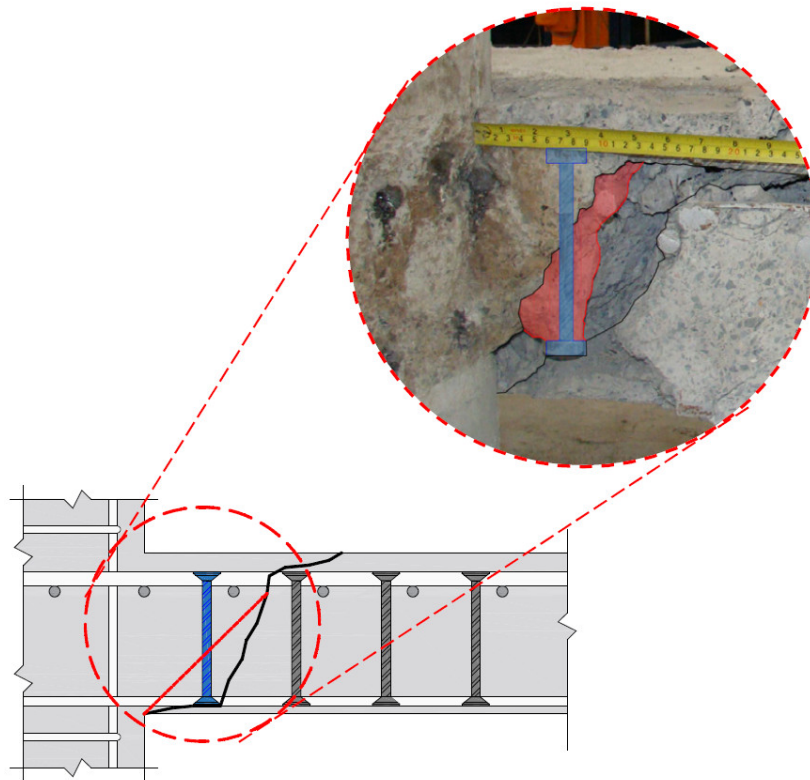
Possível evidência de armadura de cisalhamento falhando pelo arrancamento do cone de concreto (NASCIMENTO, 2020).
